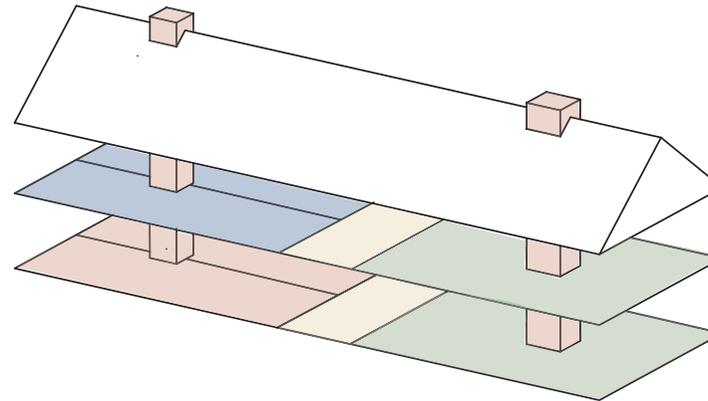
Feuerstelle Grundrissbildung
